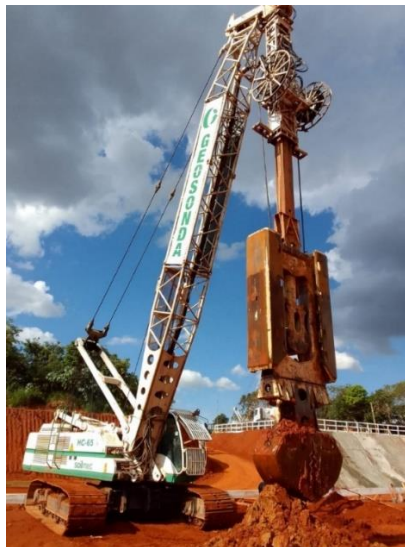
Escavação de estaca barrete utilizando polímero (Autora, 2022)
